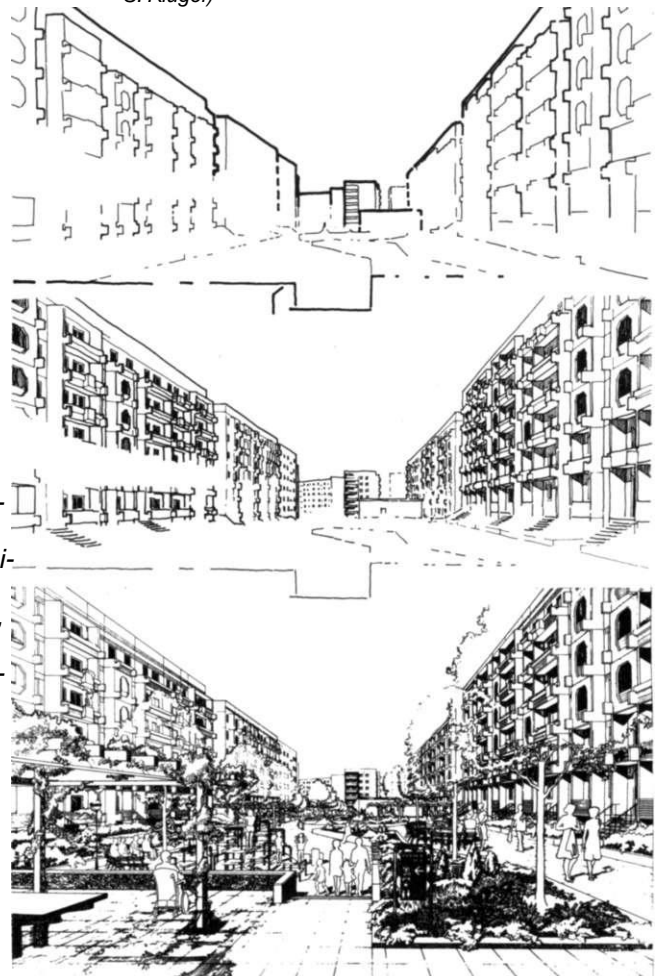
Vergleich der städtebaulichen Dichte in verschiedenen Planungsstadien
